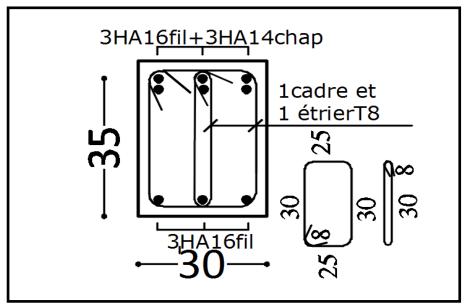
Ferraillage sur appuis d'une poutre principale
